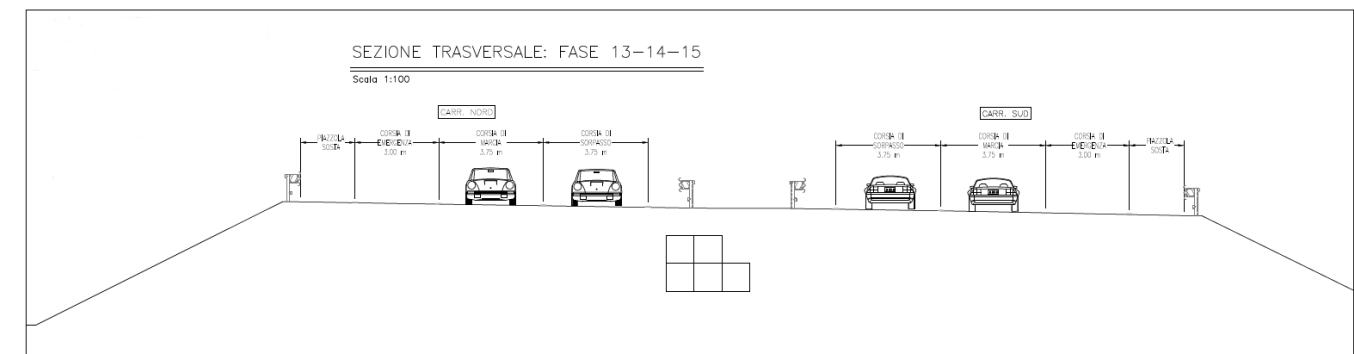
Sezione trasversale: Fasi 13 e 14
